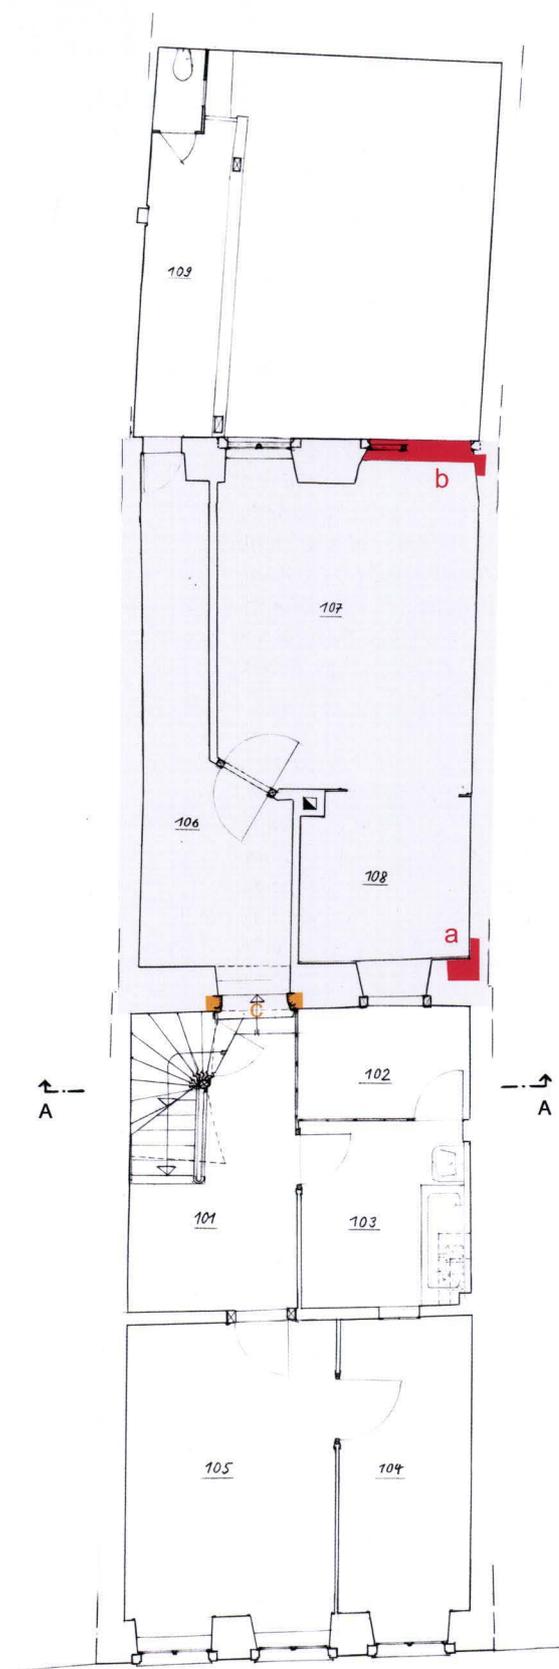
Rheingasse 15. Grundrissplan des 1. Obergeschosses. Der erste Steinbau bildet den hinteren Hausteil (hellgrau unterlegt). In der Südwest-Ecke der nachgewiesene Eckverband (a), in der Hoffassade die originale Fensterbrüstung (b). In der Scheidemauer zum vorderen Hausteil (der ehemaligen Vorderfassade) der eingebrochene Schulterbogen (c).
